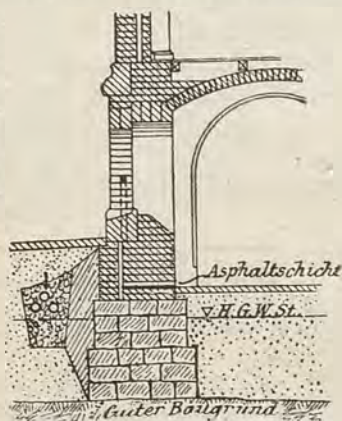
Protezione dei muri da cantina contro l'umidità.
